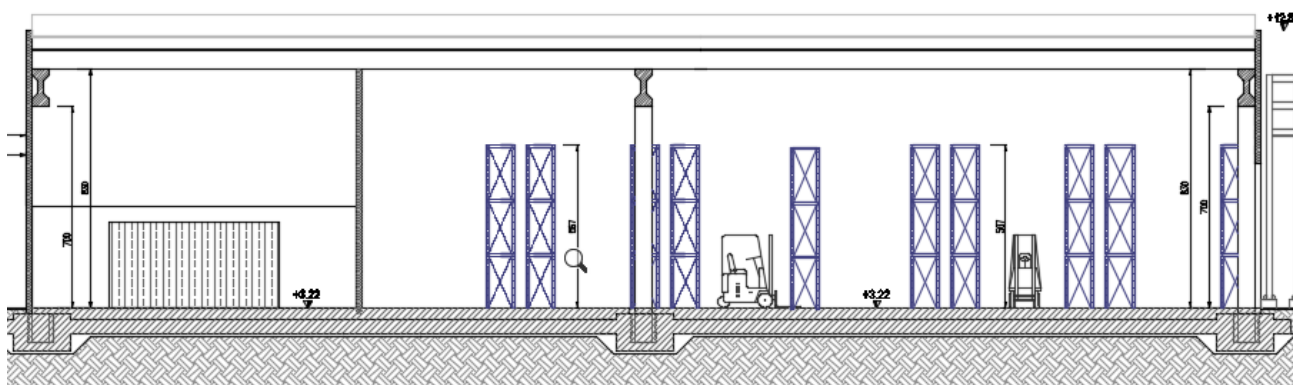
sezione trasversale capannone stoccaggio liquidi in colli per TMD (N8-N10)
